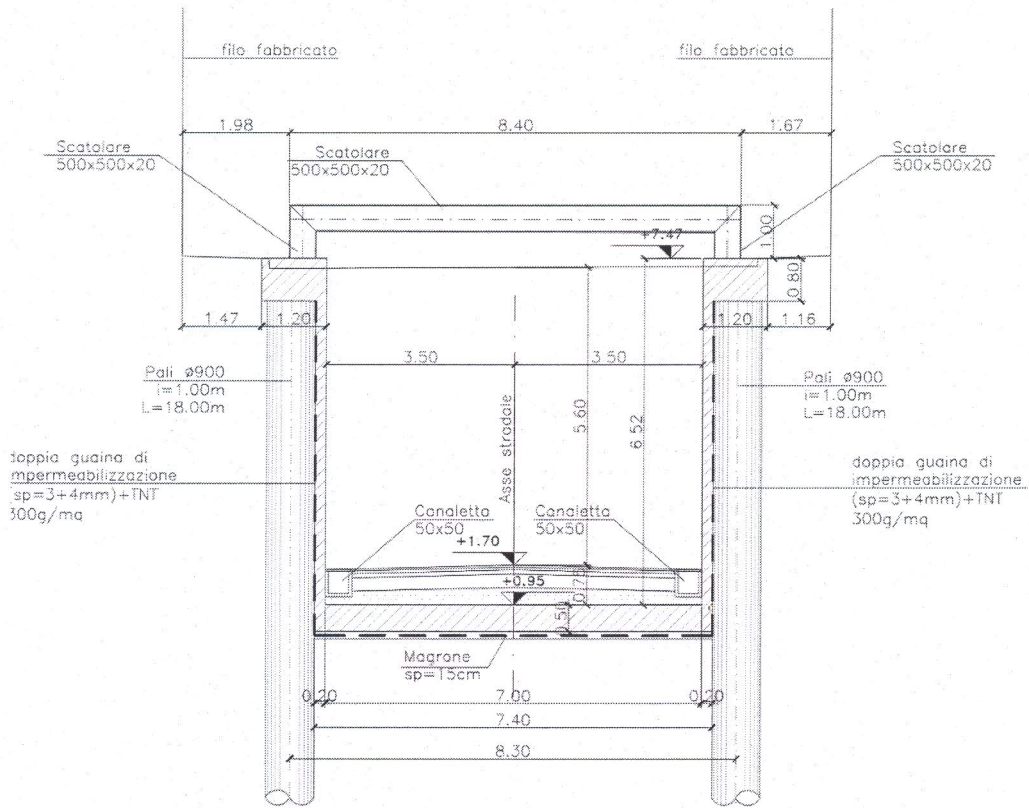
Sezione trasversale tra pk 0+136 a pk 0+154
